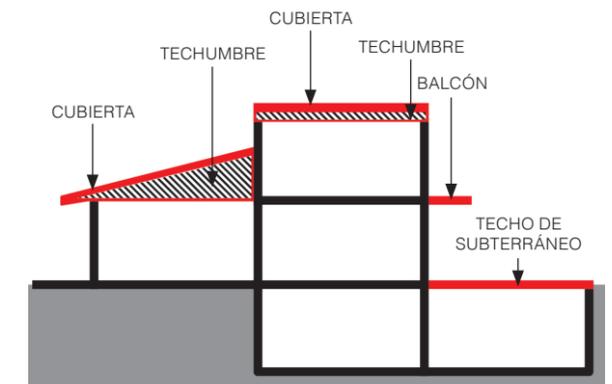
Definición cubierta y techumbre. Fuente: María Blender
